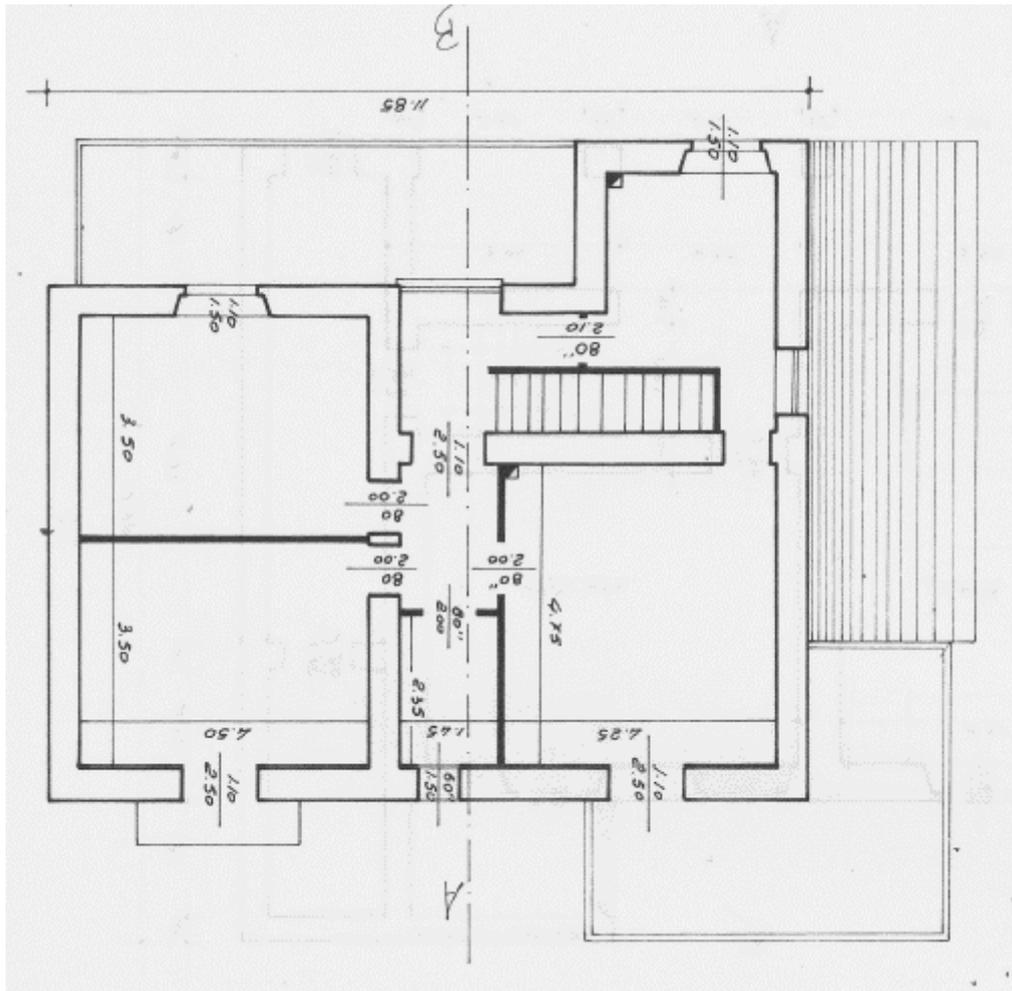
Pianta piano 1° del fabbricato principale (F. 20 p.lla 202) allegata alla Concessione Edilizia - Prot. n. 2088 del 19.6.1977
